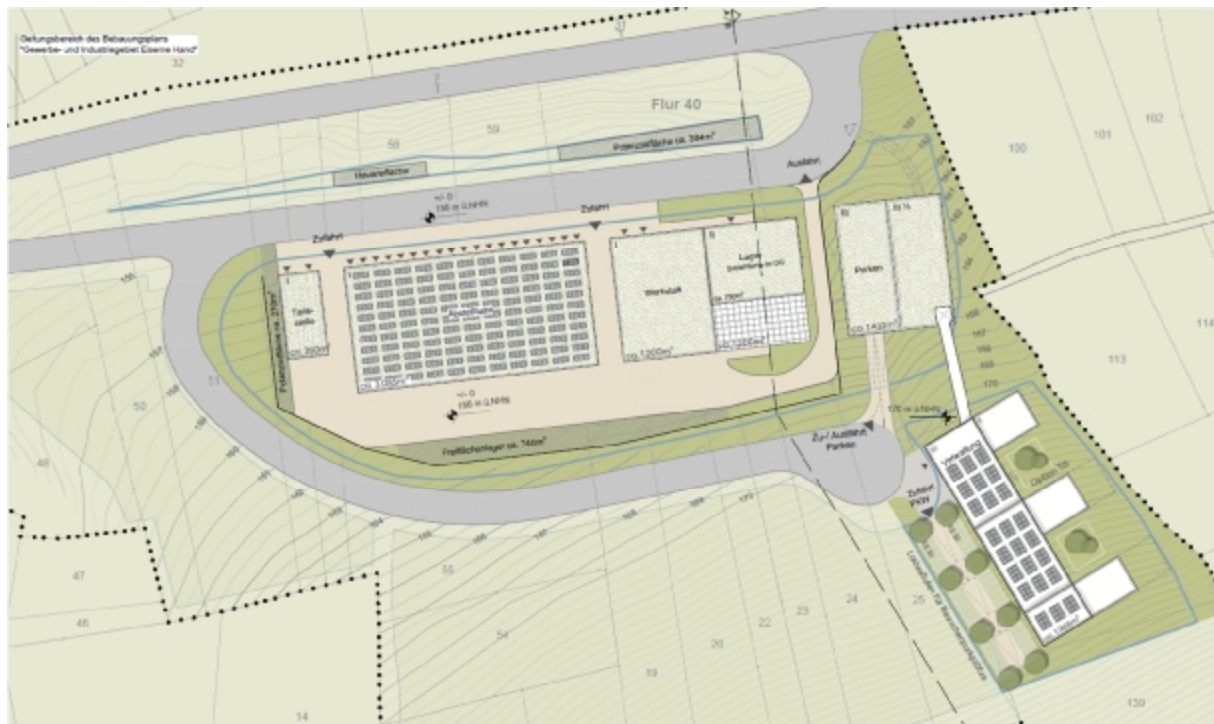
Lageplan Funktionsschema – Variante Bebauung
